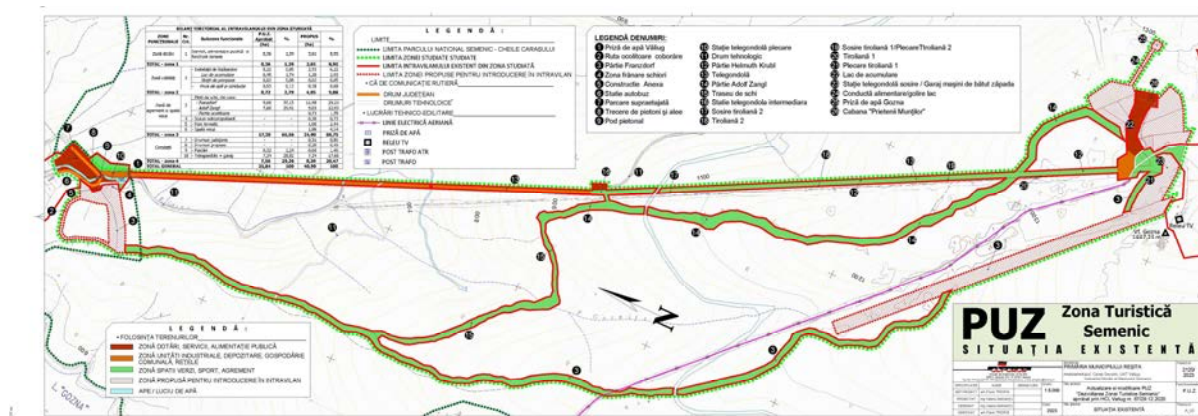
Plan de incadrare in zona PUZ Zona turistica Semenic Situatie existenta
